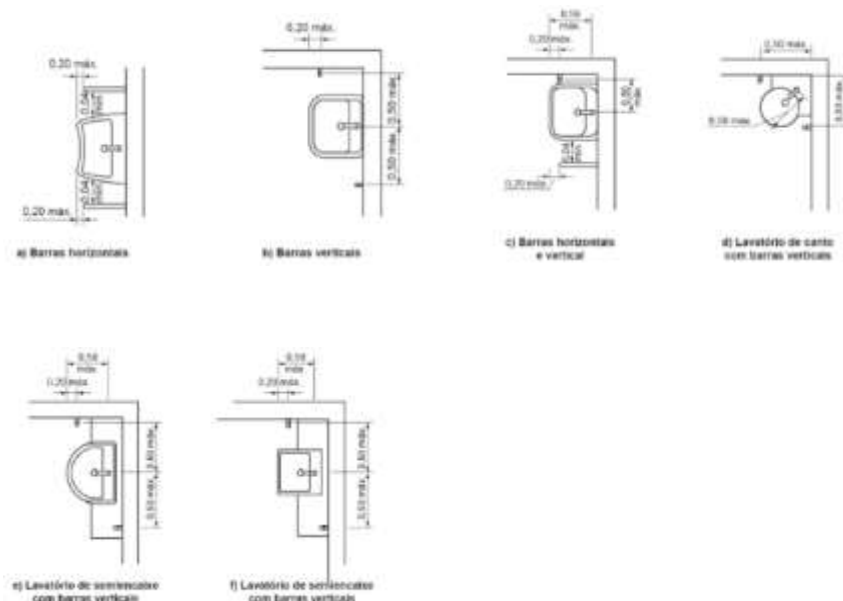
da NBR9050/20 - Barra de apoio no lavatório
